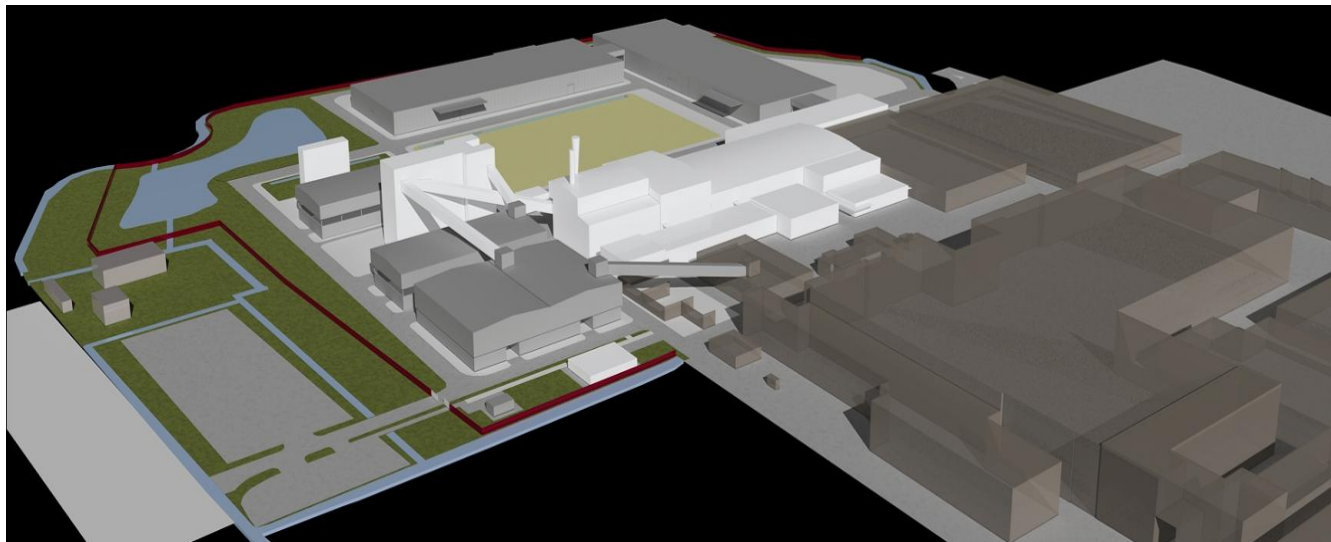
Rendering dello Stabilimento nello stato futuro
